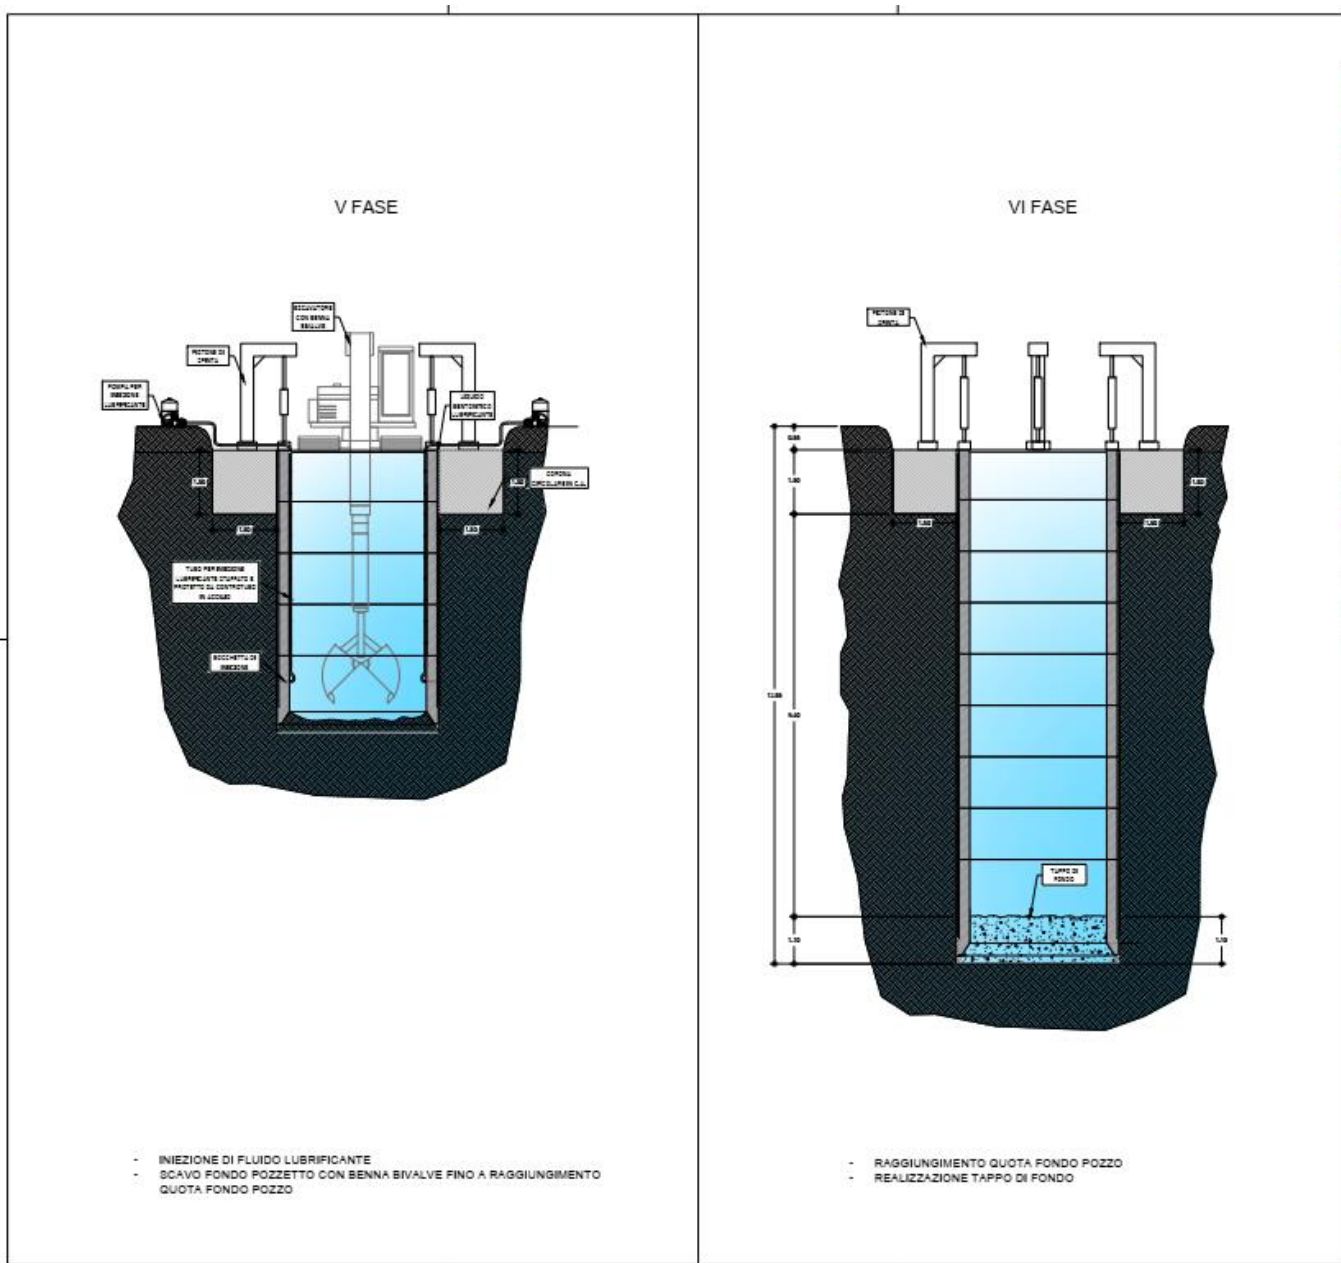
D : Schema tecnico realizzazione pozzo autoaffondante
